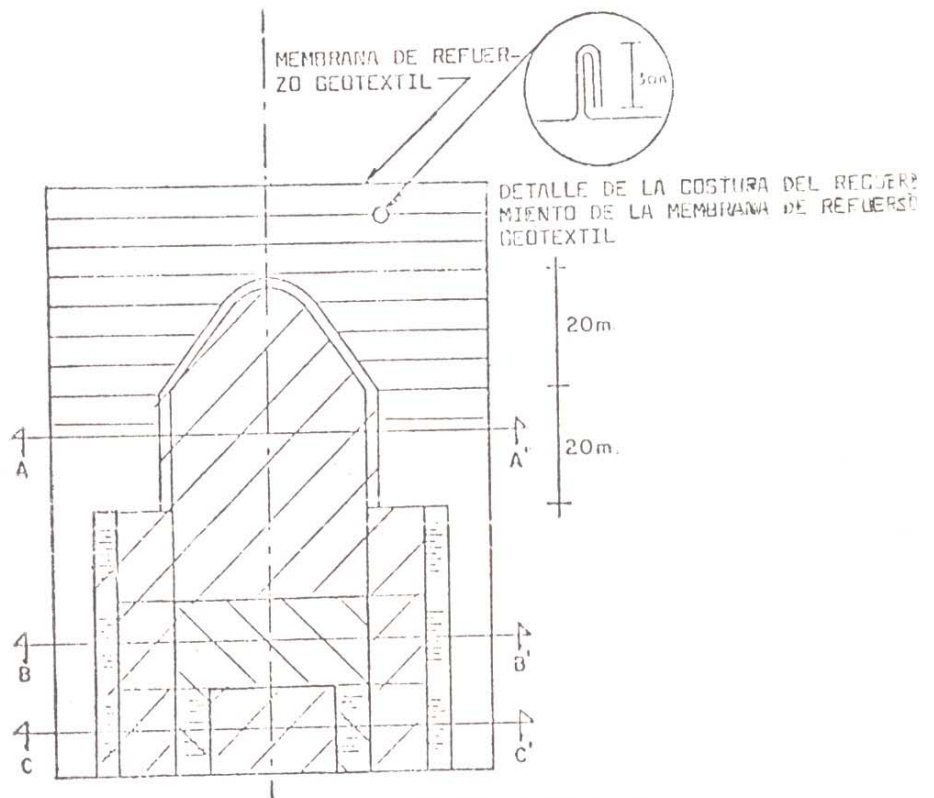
PUNTA DE AVANCE Y ETAPAS DE CONSTRUCCION (PLANTA)
